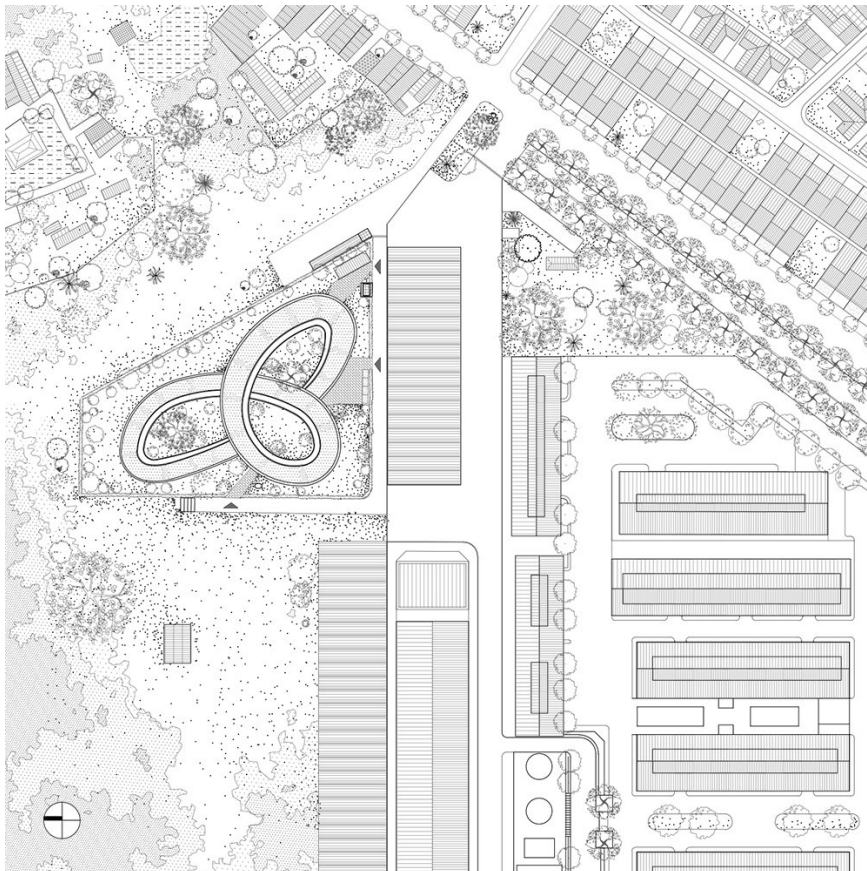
A Planta emplazamiento - Farming Kindertgarten. Fuente: Intervención propia sobre Planta extraída de Arch Daily
